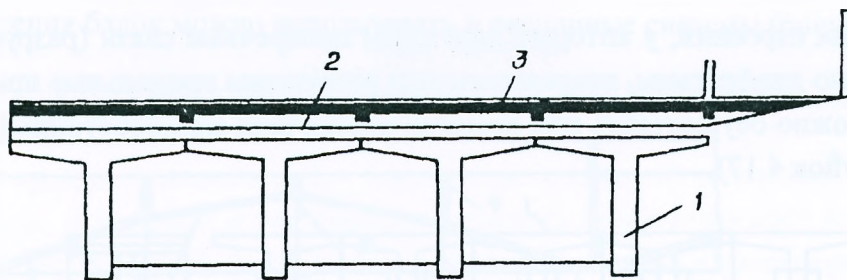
Усиление сборными плитами: 1 – балки; 2 – сборные железобетонные плиты; 3 – покрытие.
